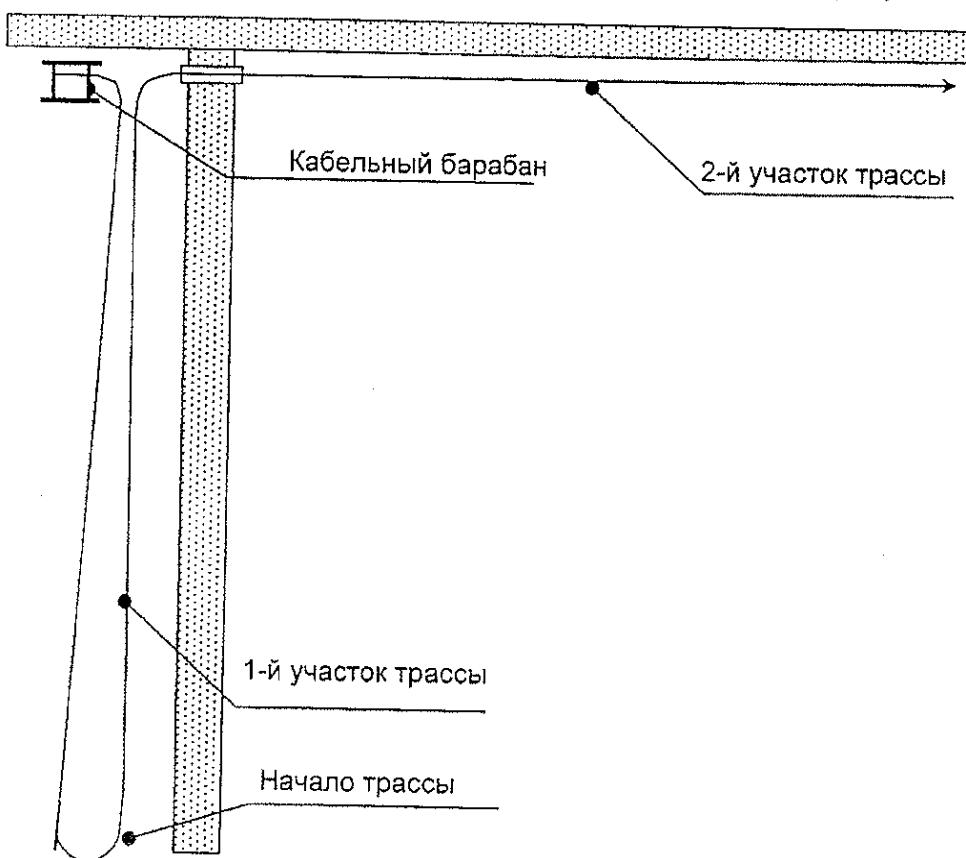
Схема раскладки кабеля с установкой кабельного барабана в промежуточной точке
